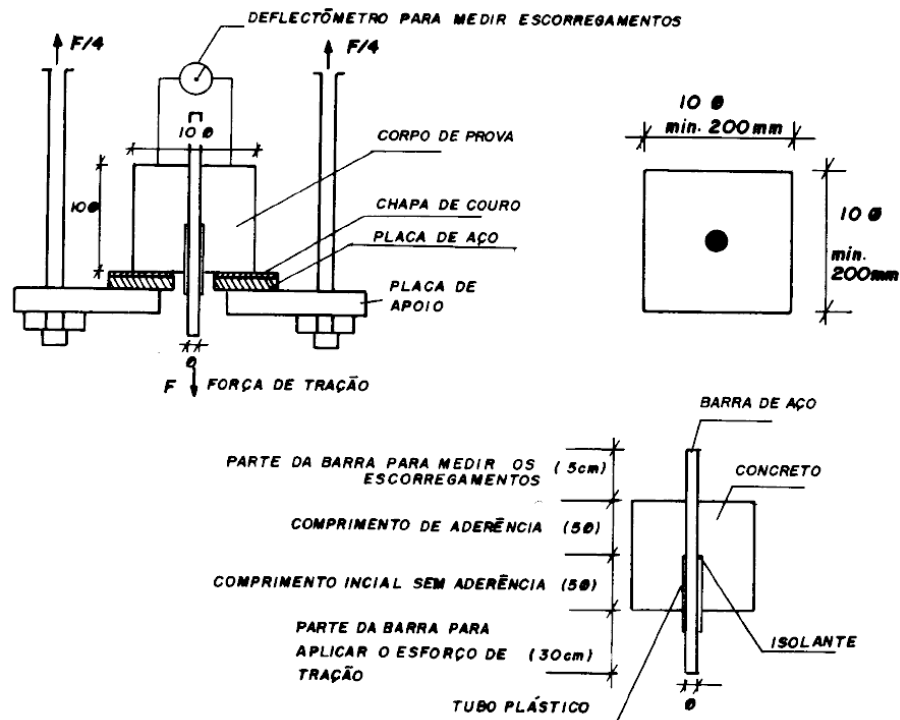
Disposição geral do ensaio de arrancamento (RILLEM, 1973).
